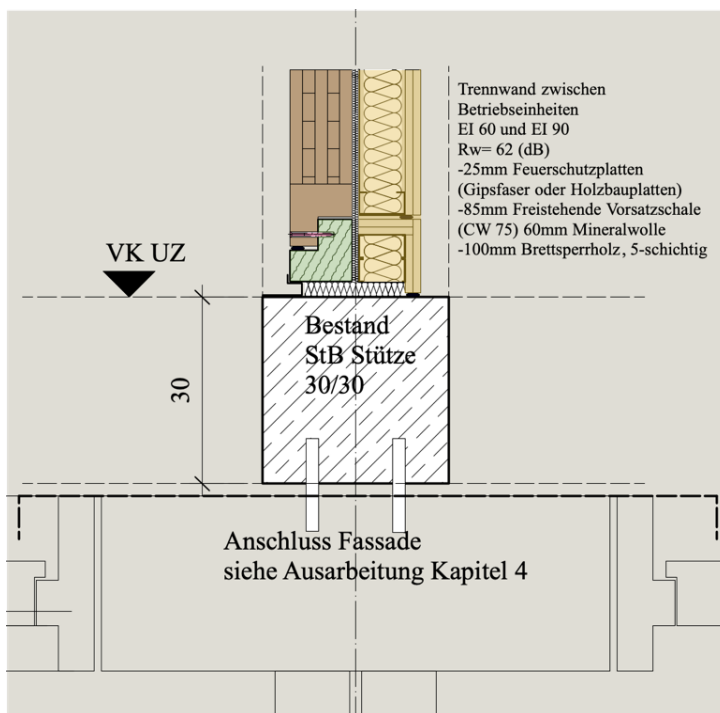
Darstellung Grundriss Anschluss zweischalige Trennwand an Fassadenstütze
